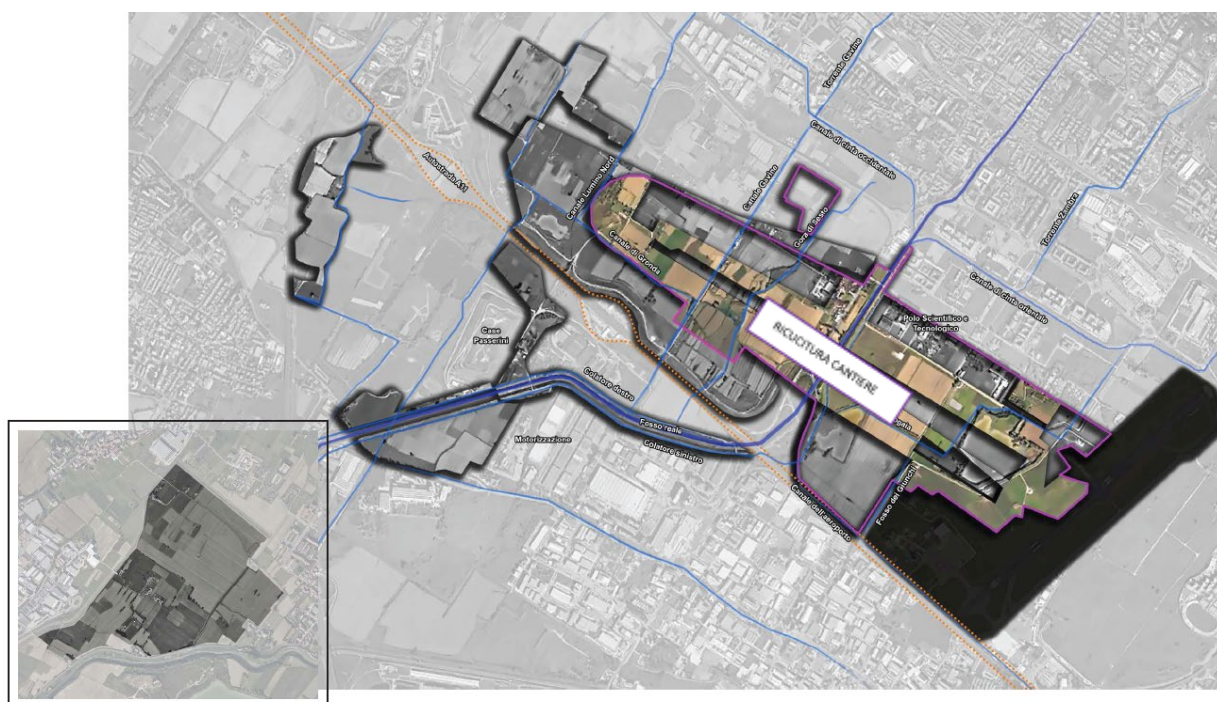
Planimetria di cantierizzazione: ricucitura macro lotti
